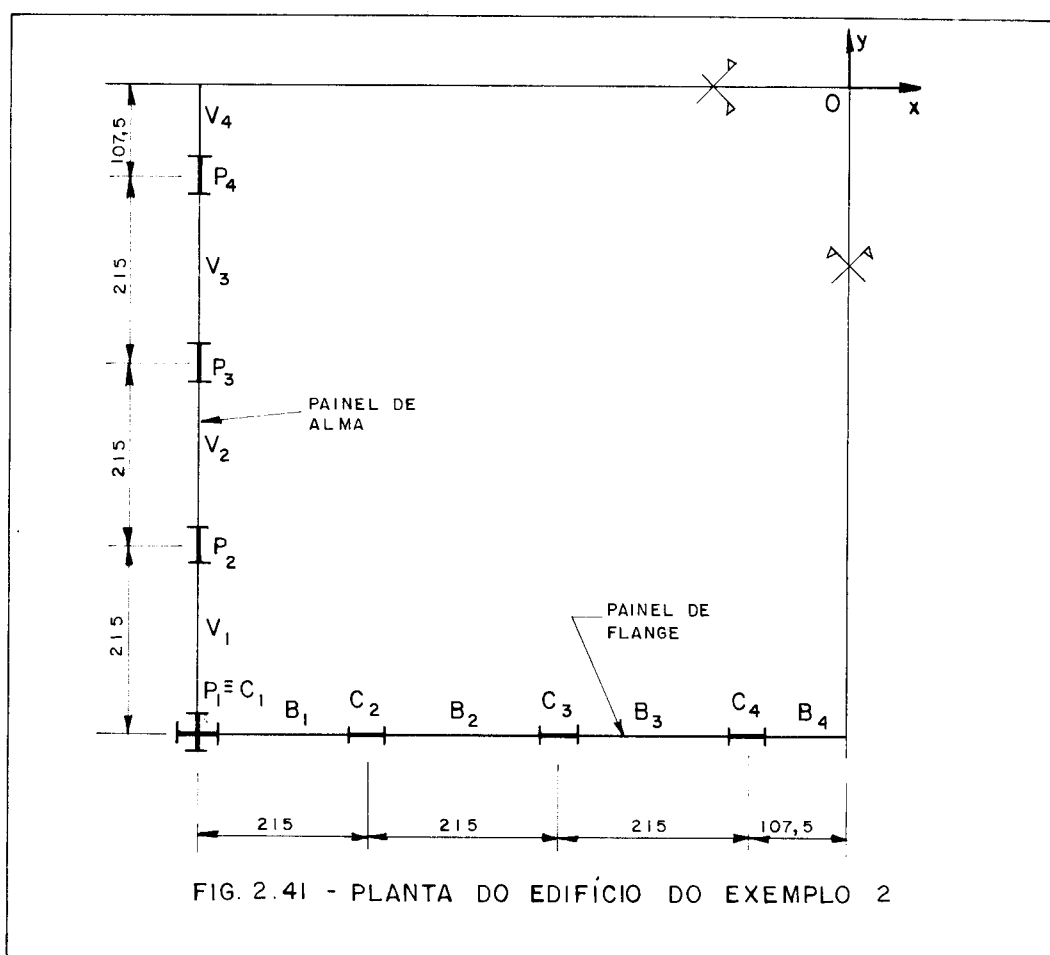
PLANTA DO EDIFÍCIO DO EXEMPLO 2
